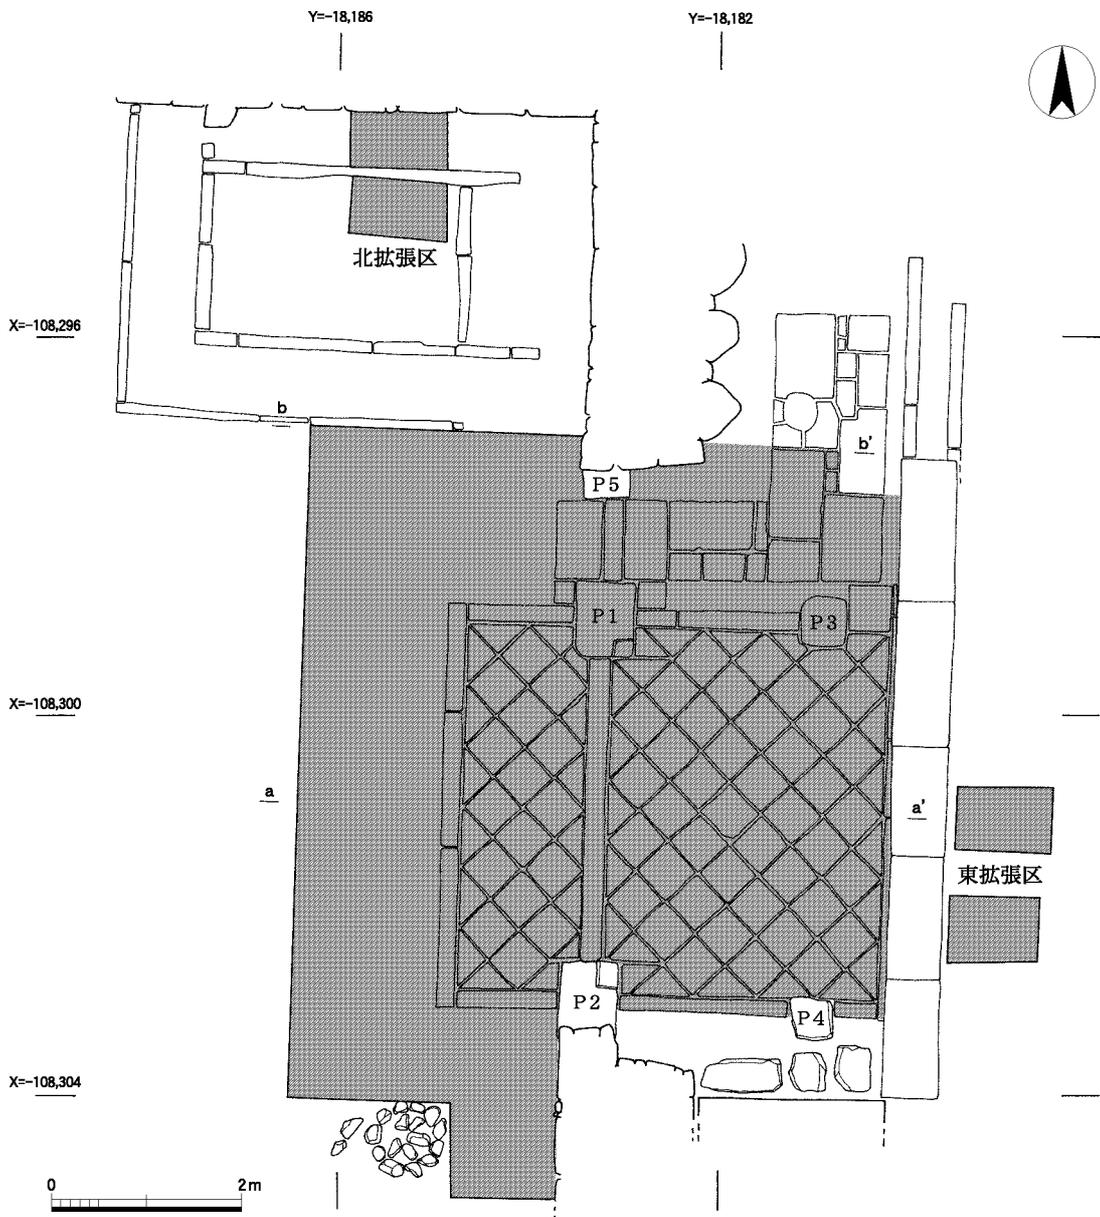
A区 第1面中門基壇平面図および調査区配置図( 1 : 80 )
